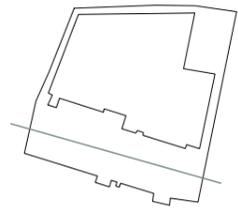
Bestandsplan, Schnitt A, M 1:150
